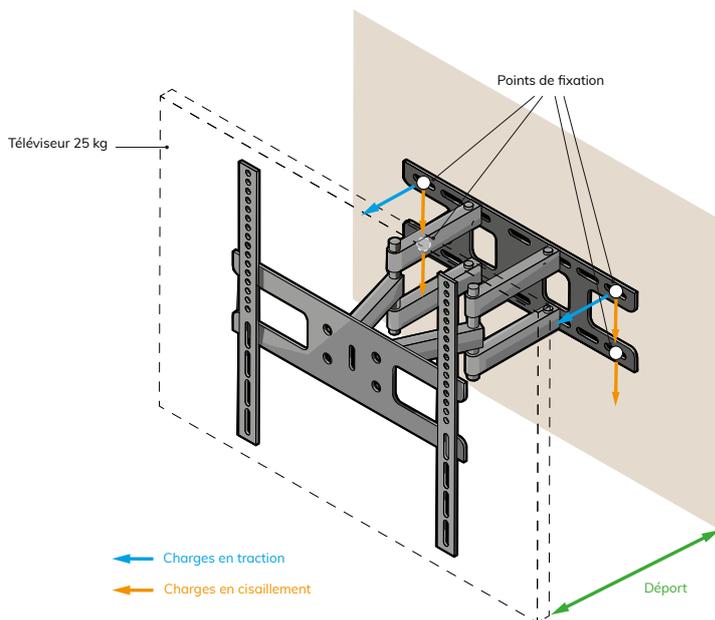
exemple de fixation d'un téléviseur avec bras articulé sur double rail fixé au mur
